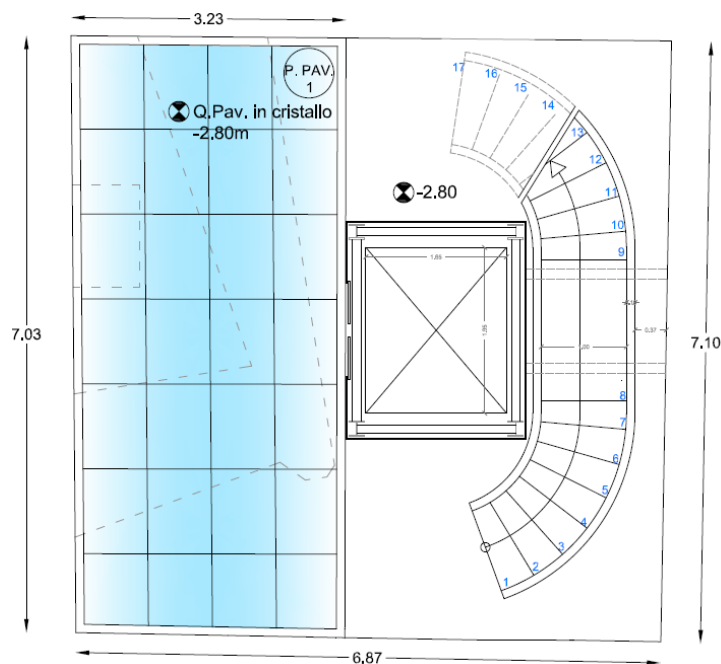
Stralcio planimetrico con pavimentazione sospesa
